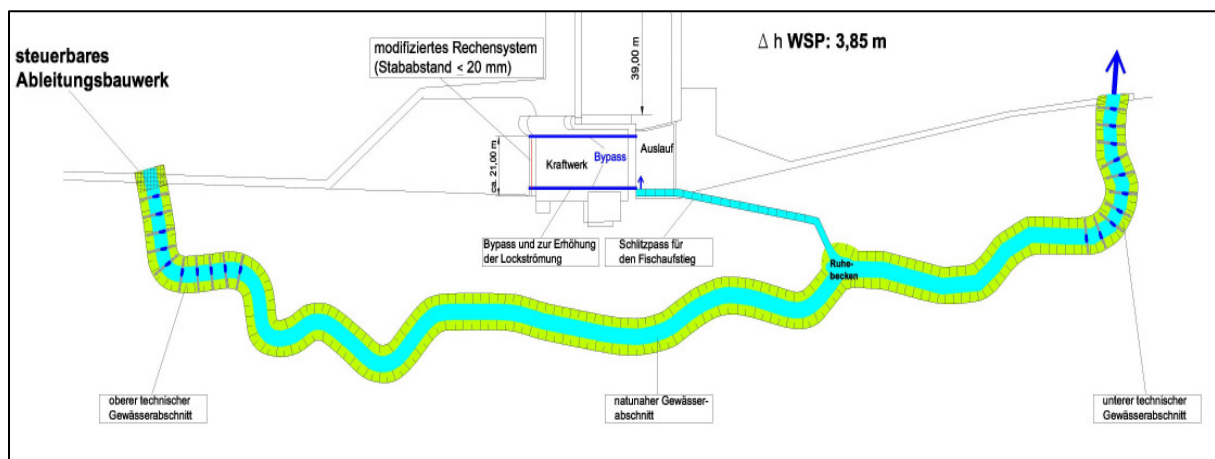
Lageplanskizze Staufstufe Mühlheim mit Darstellung der Fischwanderhilfe
